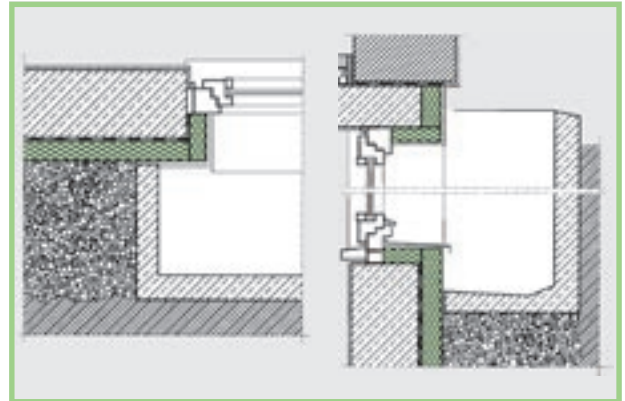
Wärmebrückenfreier Anschluss eines Betonlichtschachtes.
